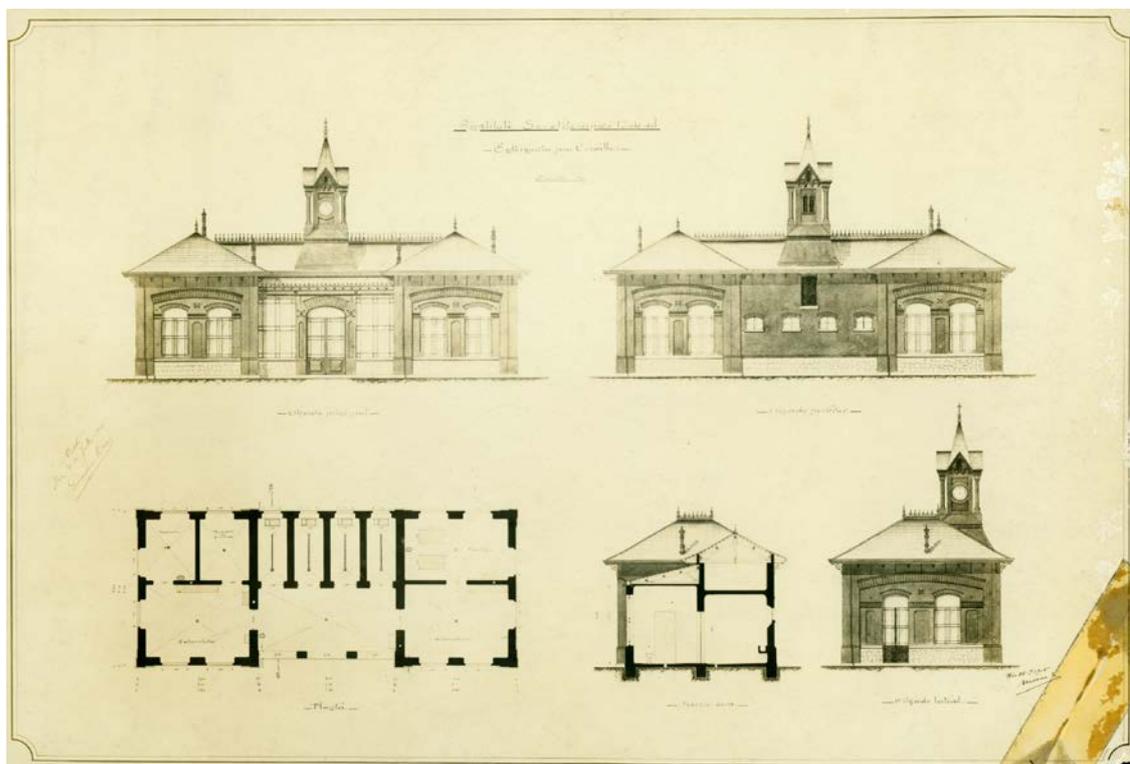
Planta baixa, fachadas e cortes do Pavilhão da Peste
